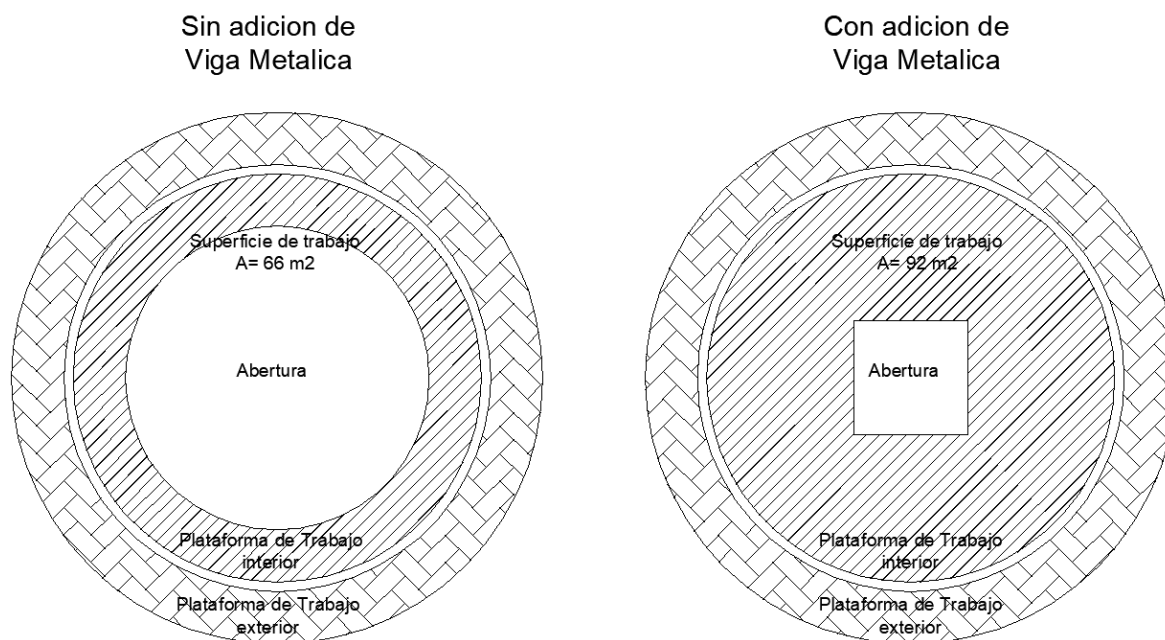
Detalle de Viga Metálica anclada al Molde. Vista en planta
